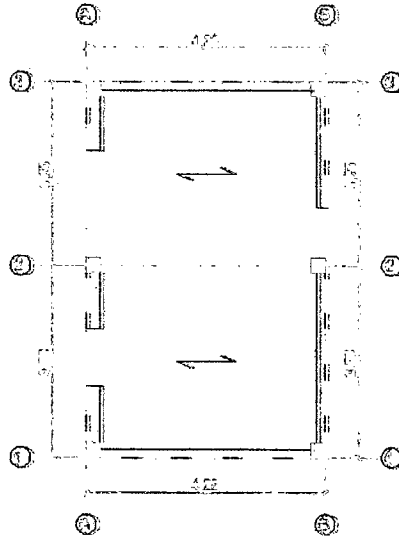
Plano de estructuras de la planta típica de la Vivienda TV7.
